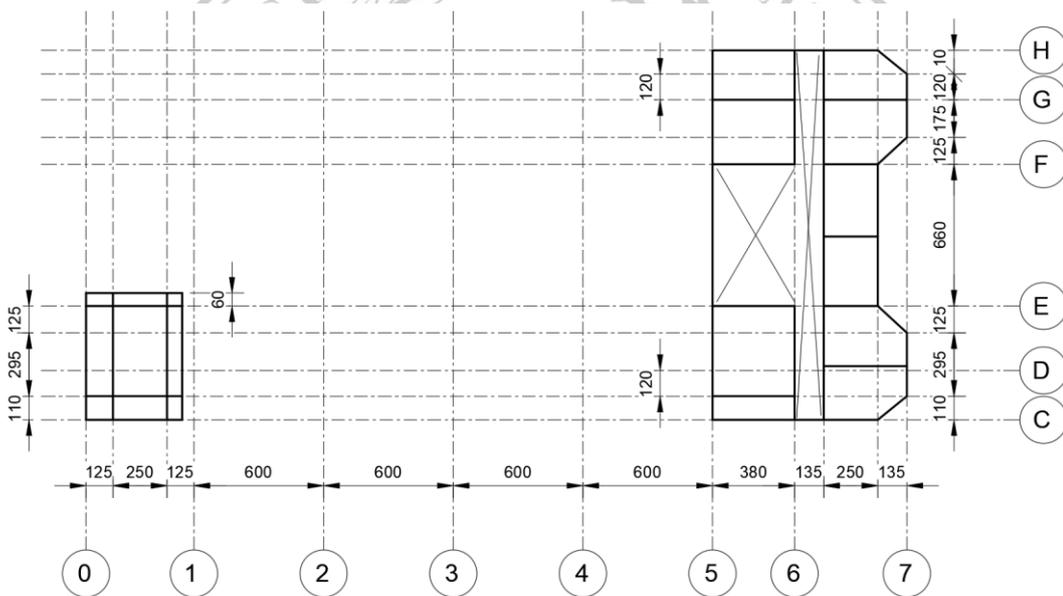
3 Denah lantai 5-7 elevasi +21,40-29,40
